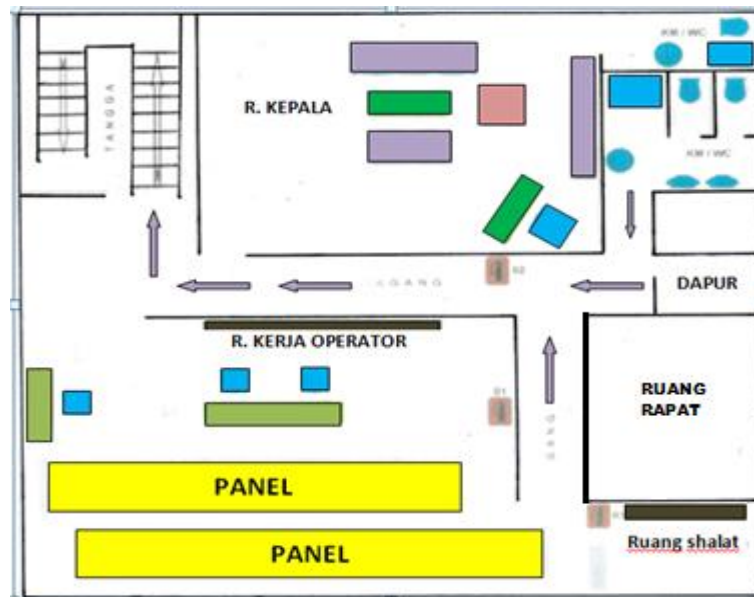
Bangunan Sentral PLTA Batang Agam Lantai II
